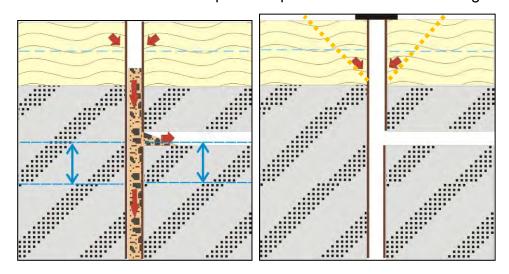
schémas illustrant le débourrage de remblai (à gauche) et la rupture du revêtement (à droite) d'un puits
